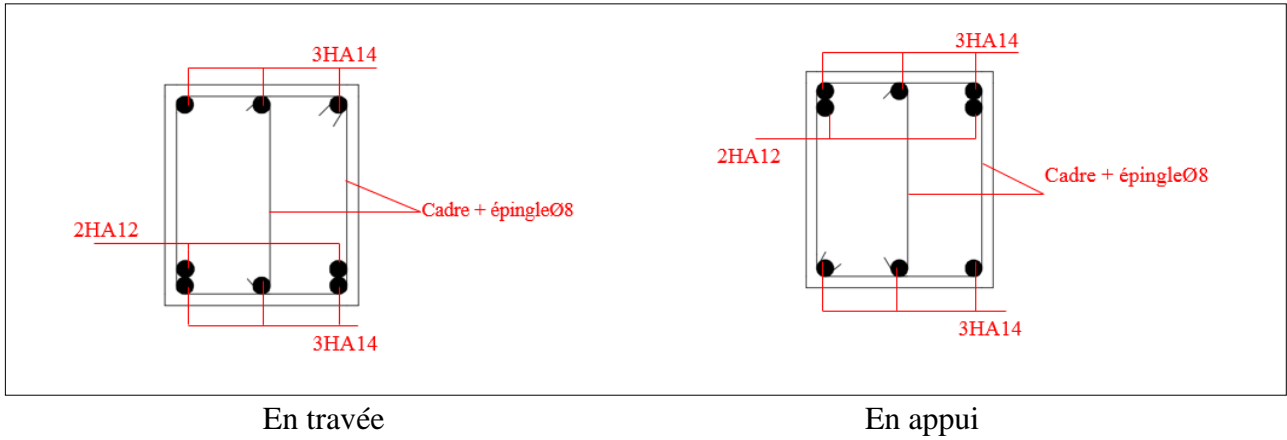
schéma de ferrailage de la poutres principales RDC et 1^{er}, 6^{eme}, 7^{eme} étage.
